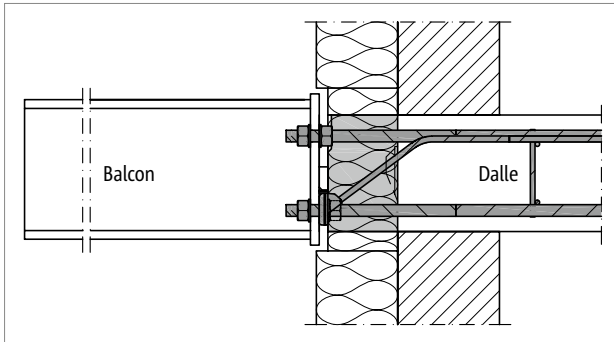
Schöck Isokorb® XT type SK : raccordement à la dalle en béton armé ; corps isolant à l'intérieur de l'isolation thermique extérieure
